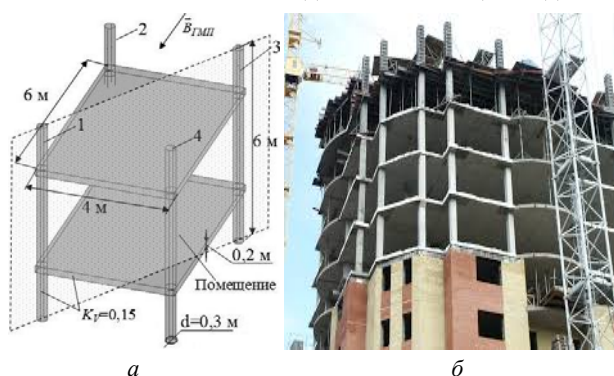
Упрощенная физическая модель железобетонной конструкции (а), определяющая уровень ослабления ГМП в помещении типового каркасно-монолитного дома (б)
